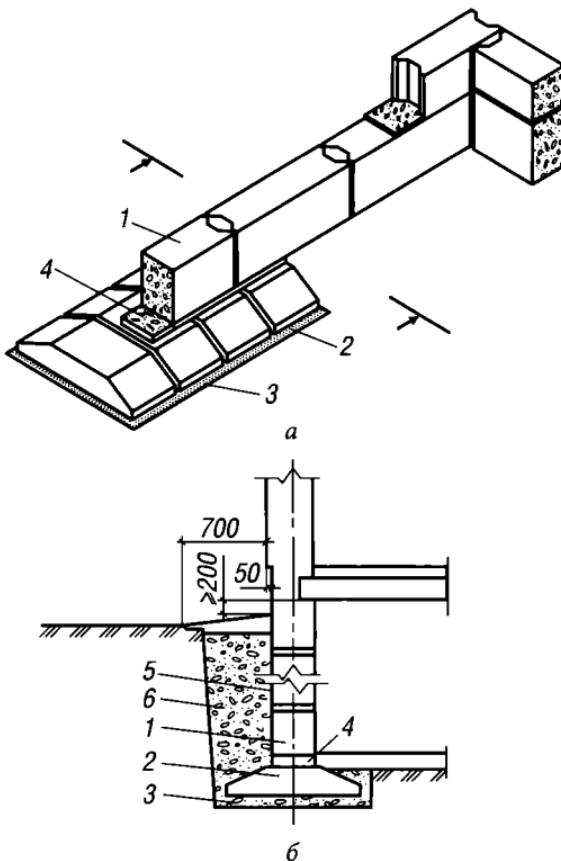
Ленточный фундамент из сборных бетонных блоков:
